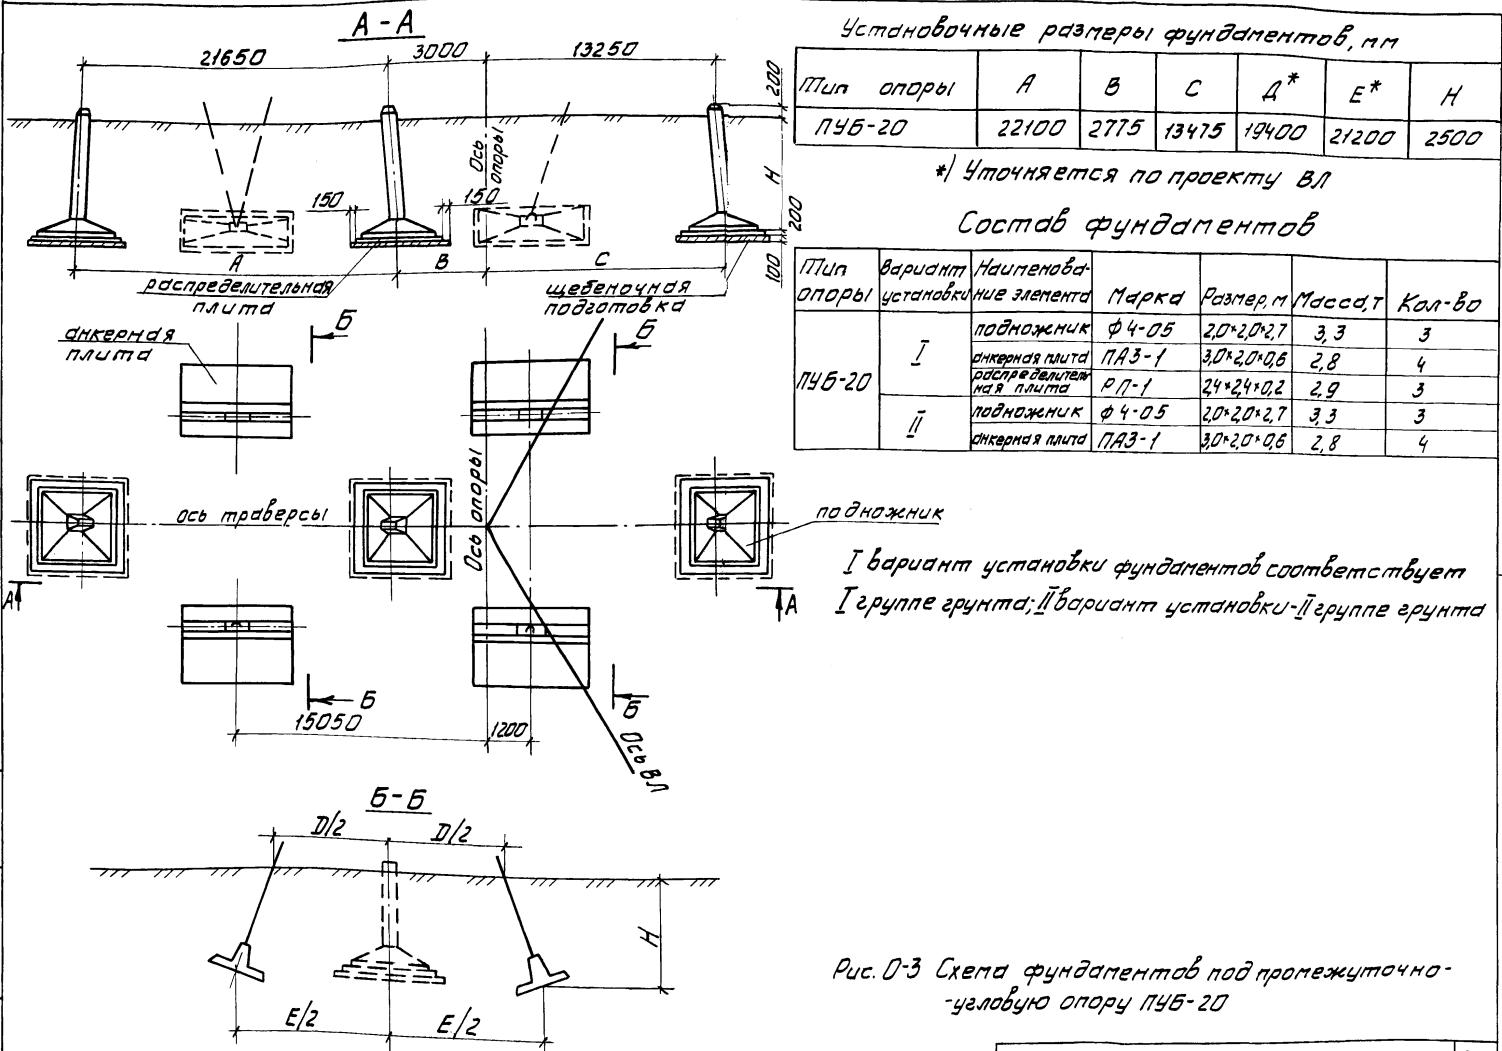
Схема фундаментов под промежуточно-угловую опору ПУБ-20
